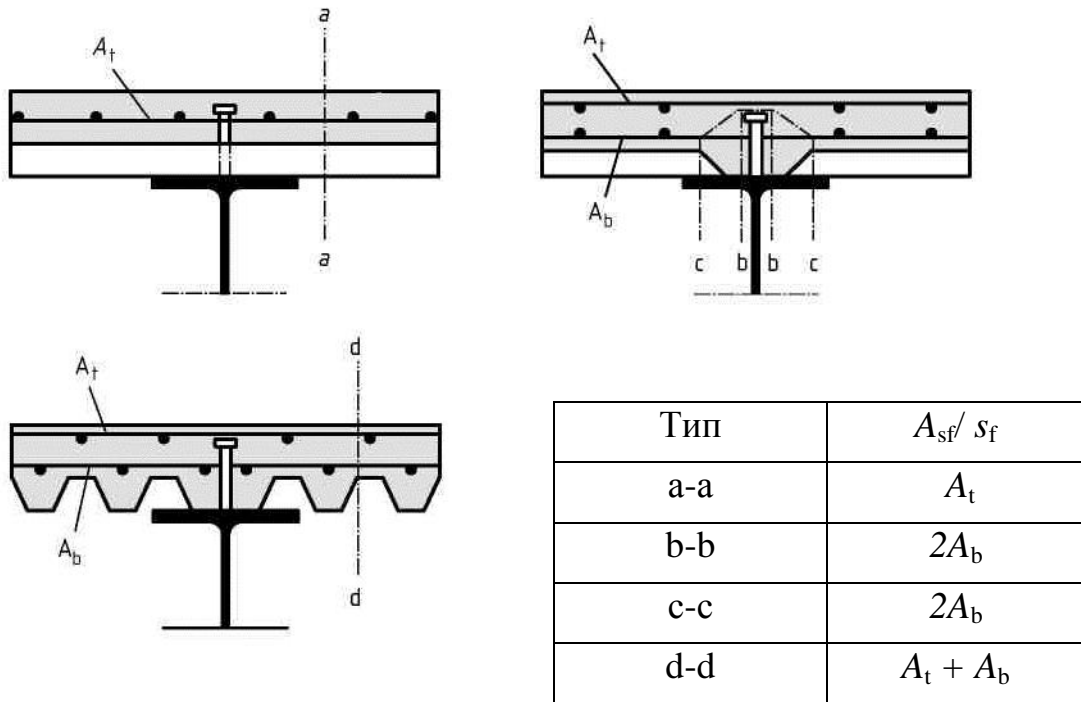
Типові потенціальні поверхні руйнування від зсуву при застосуванні профнастилу
